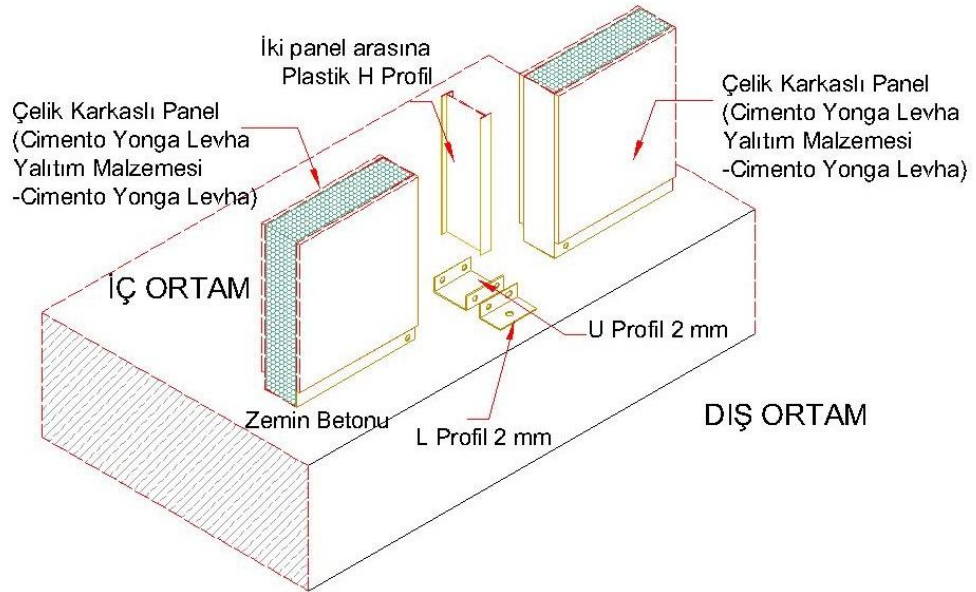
Örnek bir hafif çelik yapı için temel planı
